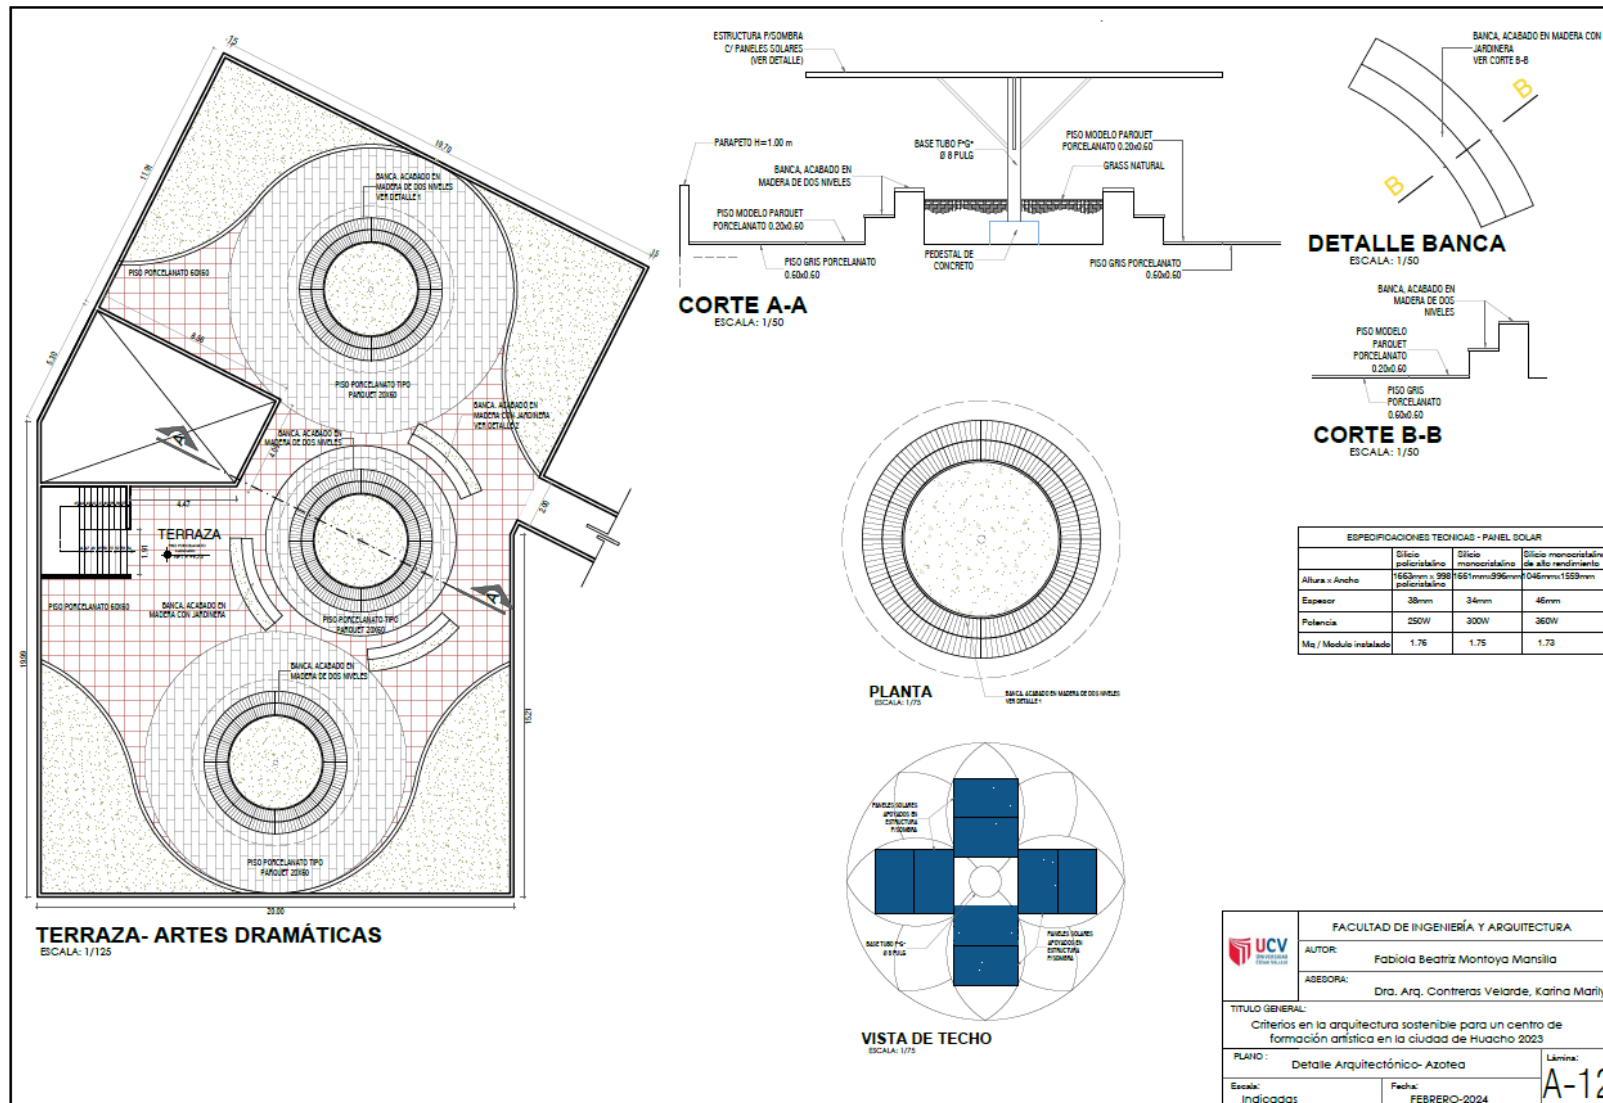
Plano de Detalles Arquitectónicos 3, Azotea de Escuela de Arte Dramático
